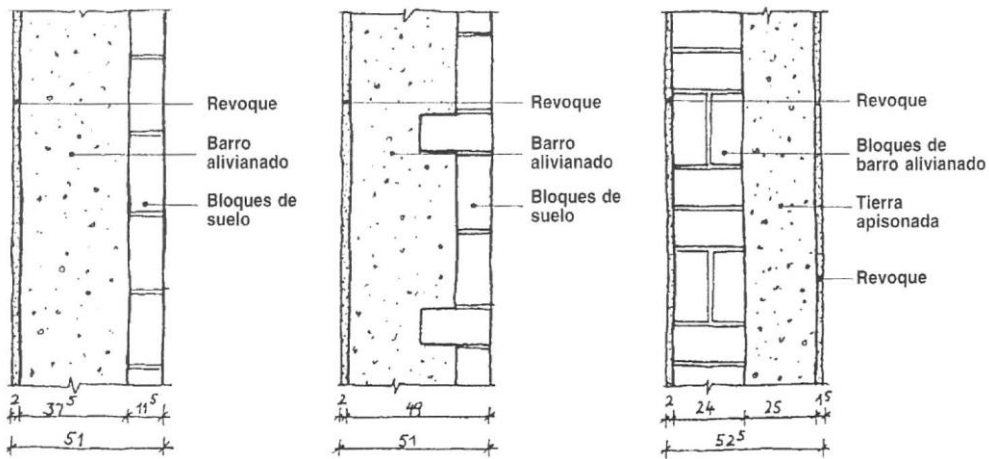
Secciones horizontales de muros de barro alivianado apisonado con una cara de bloques de suelo actuando como encofrado perdido.
